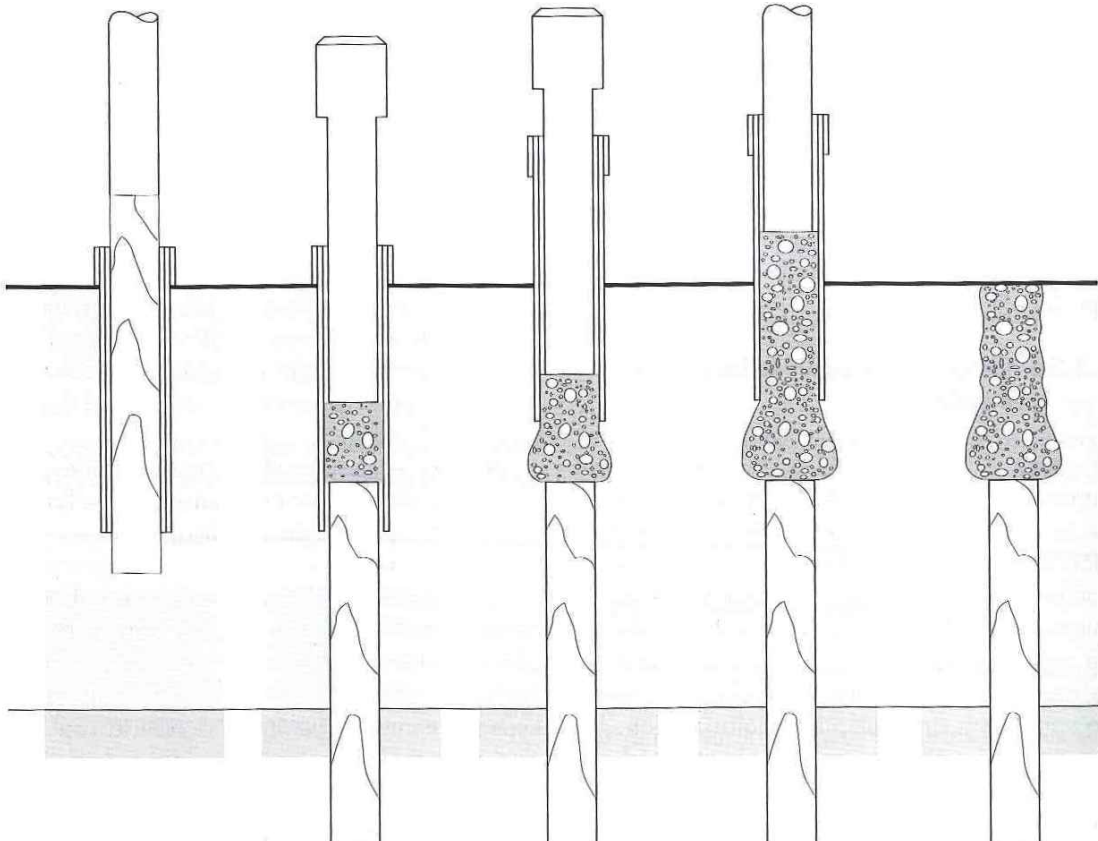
Proceso de construcción de un pilote mixto madera-hormigón
